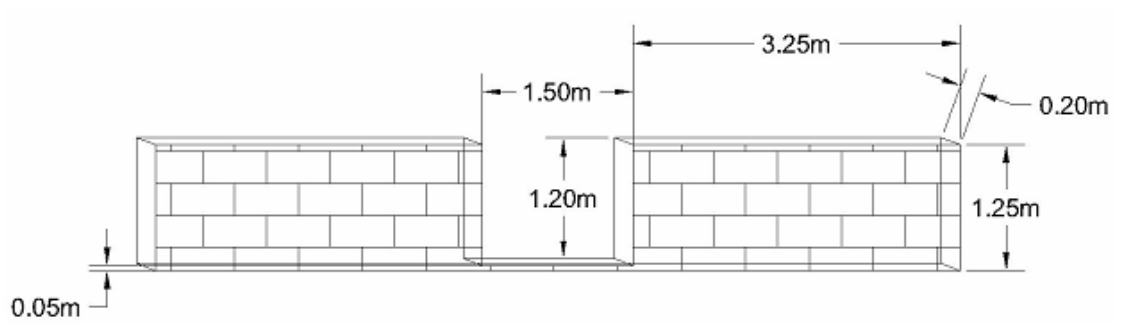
Muro frontal de protección prefabricado con acceso a los graderíos
